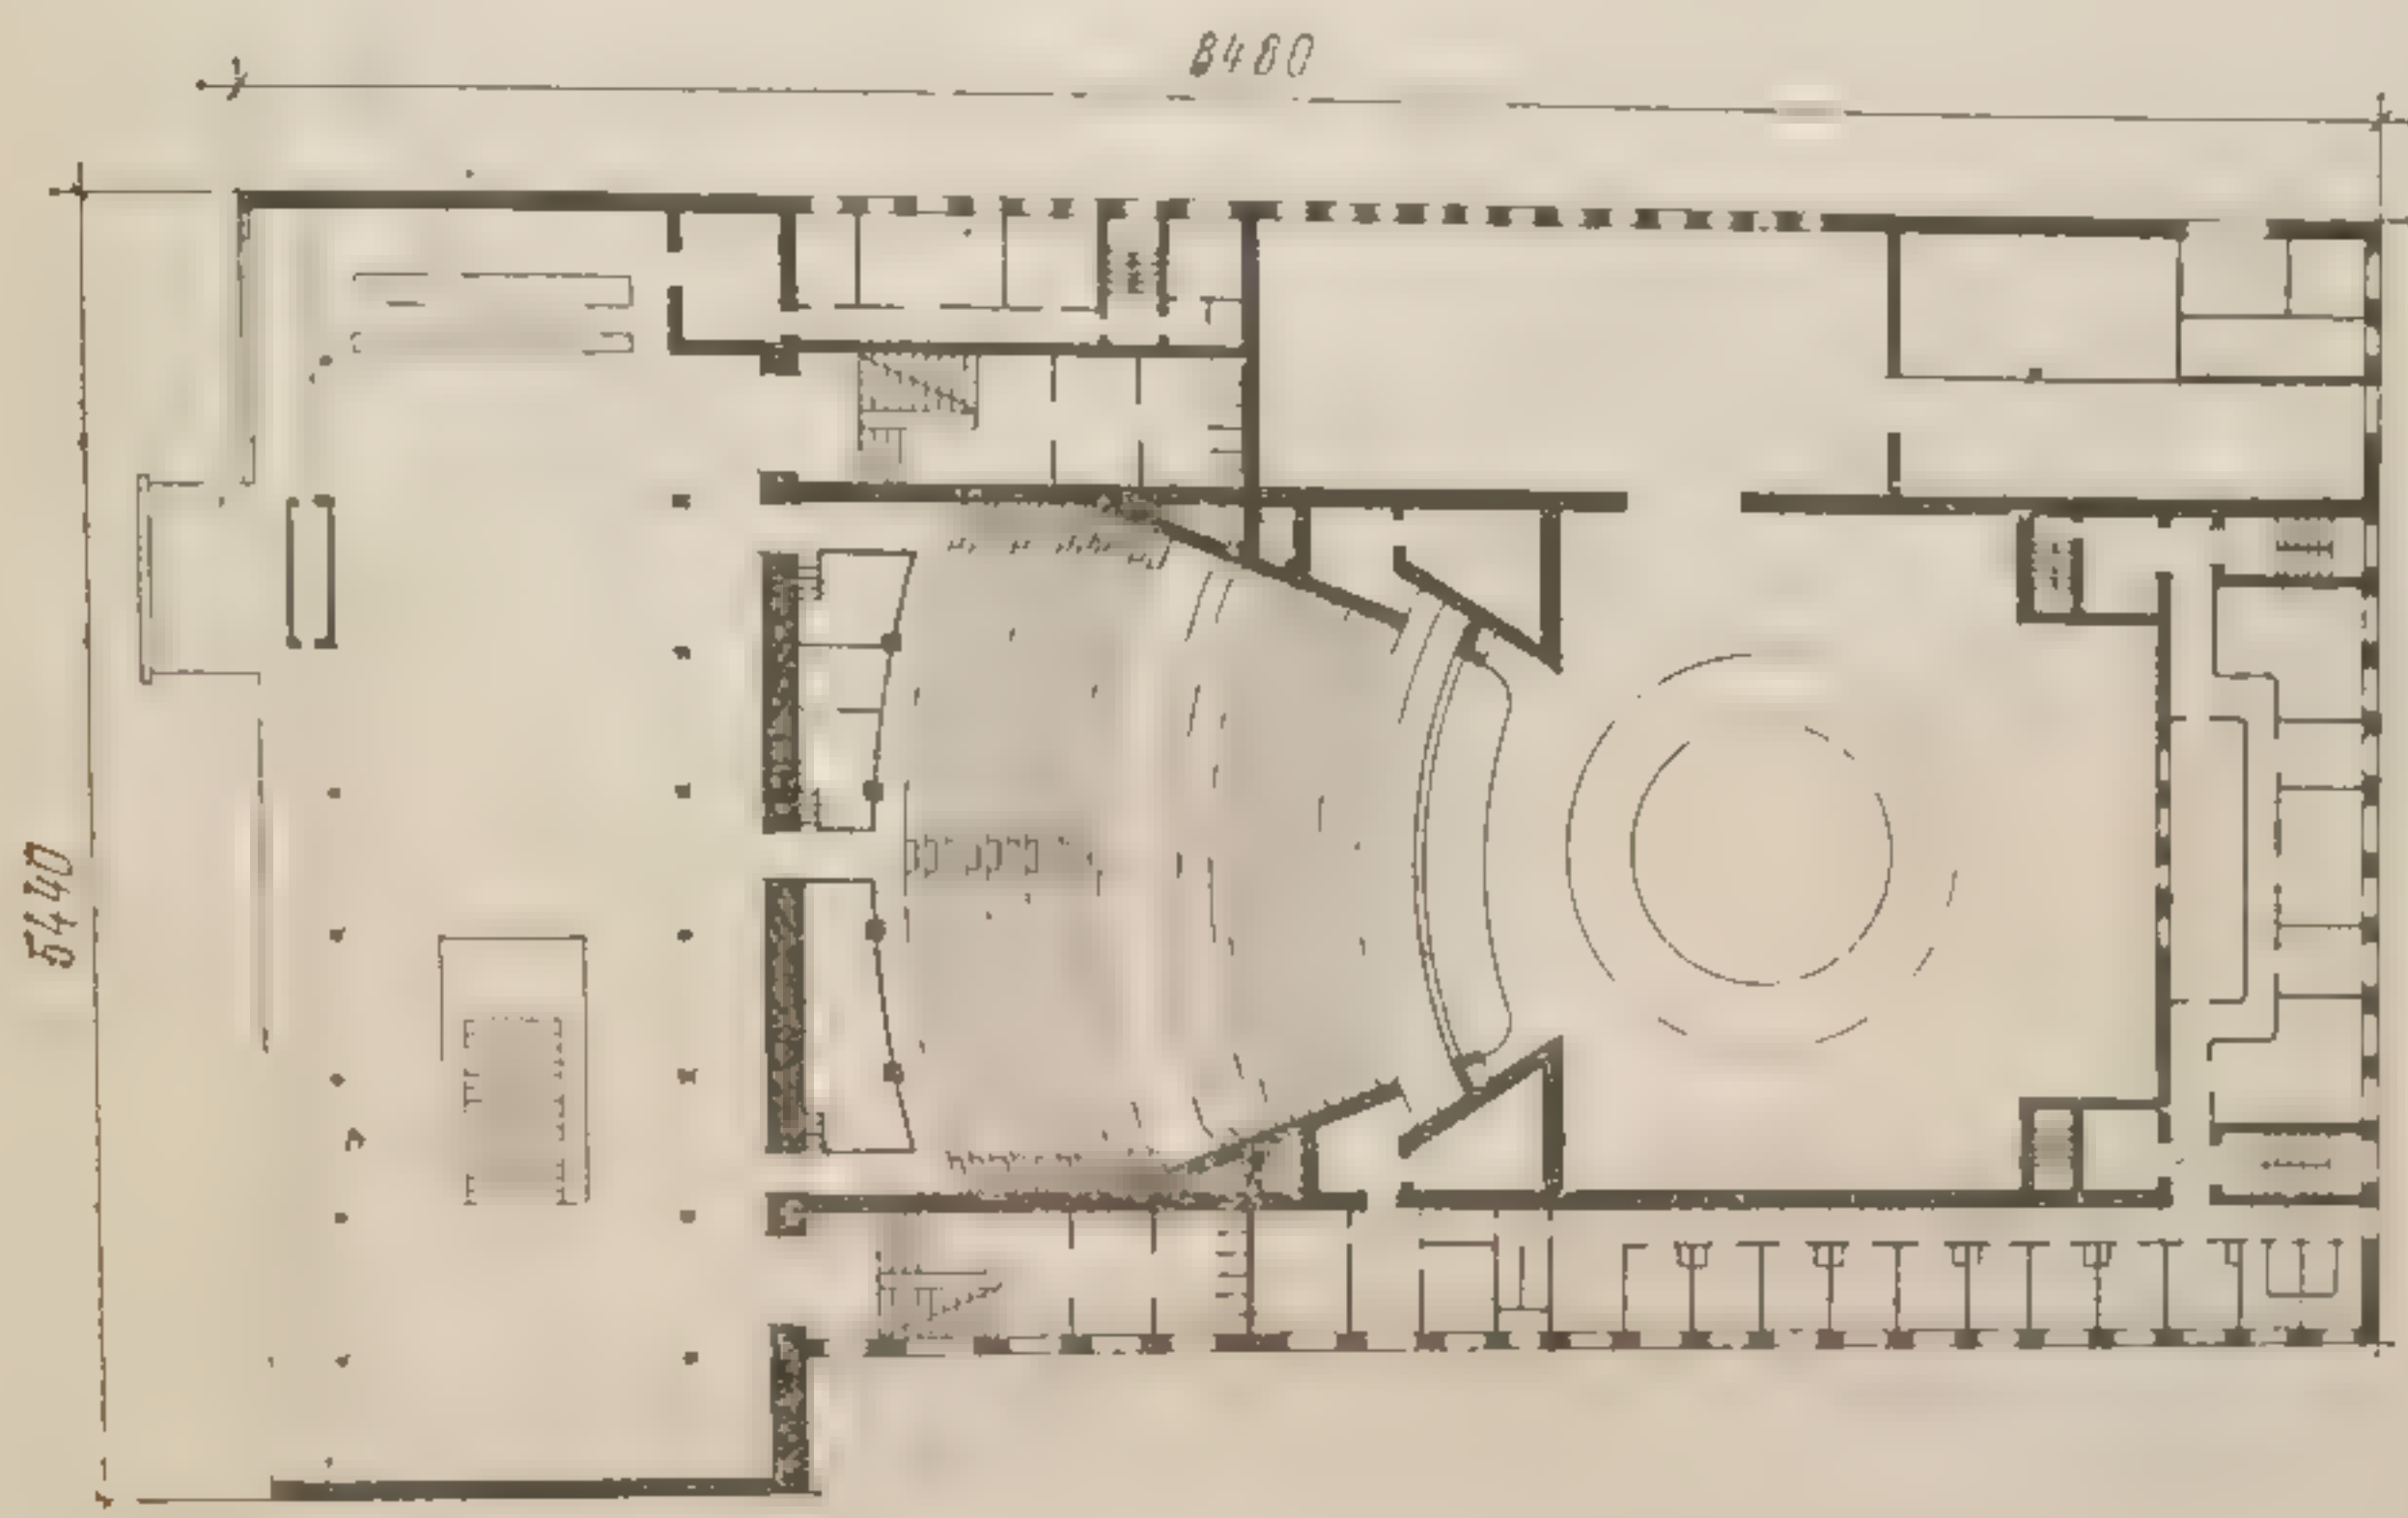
Театр музыкальной комедии в Краснодаре. План первого этажа
